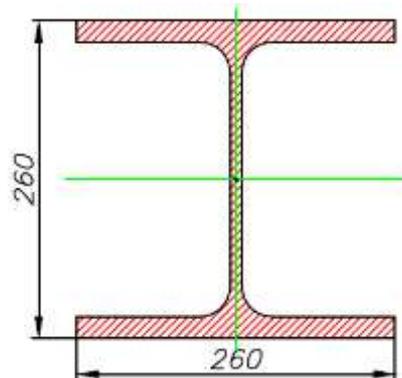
Sección transversal viga Carrilera Fuente: (Autor)
